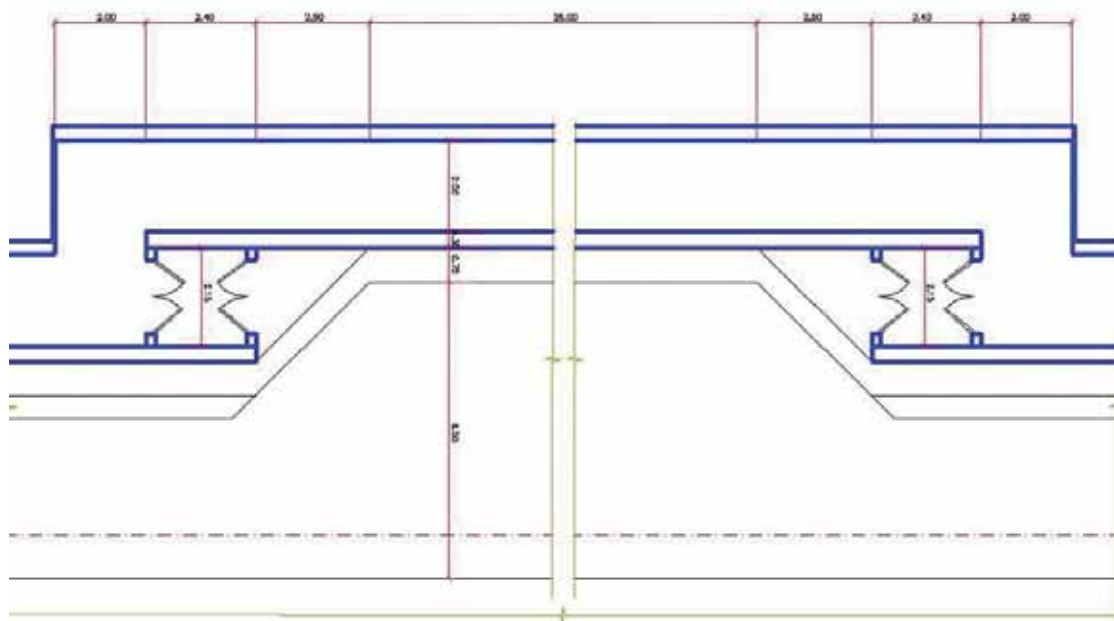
Nueva sección transversal especial adoptada de apartadero con salida de emergencia
